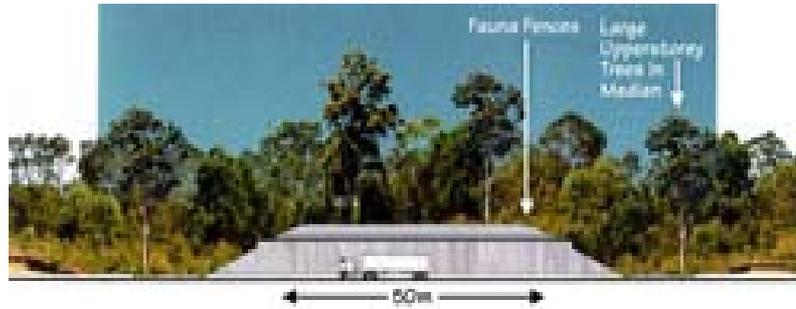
Projeto-“ Ponte-terra”, overpasse para proteção da fauna
